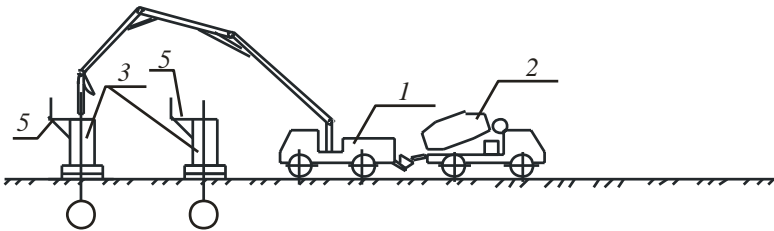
Технологическая схема бетонирования фундаментов при помощи автобетононасоса:
